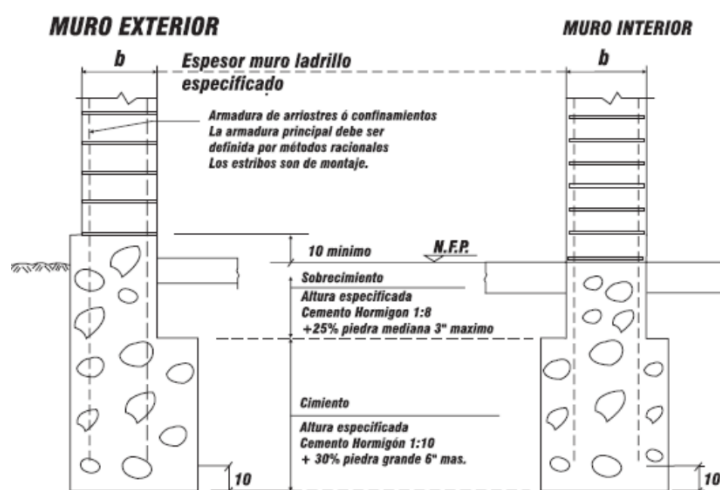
Cimentación en viviendas de albañilería – RNE.
